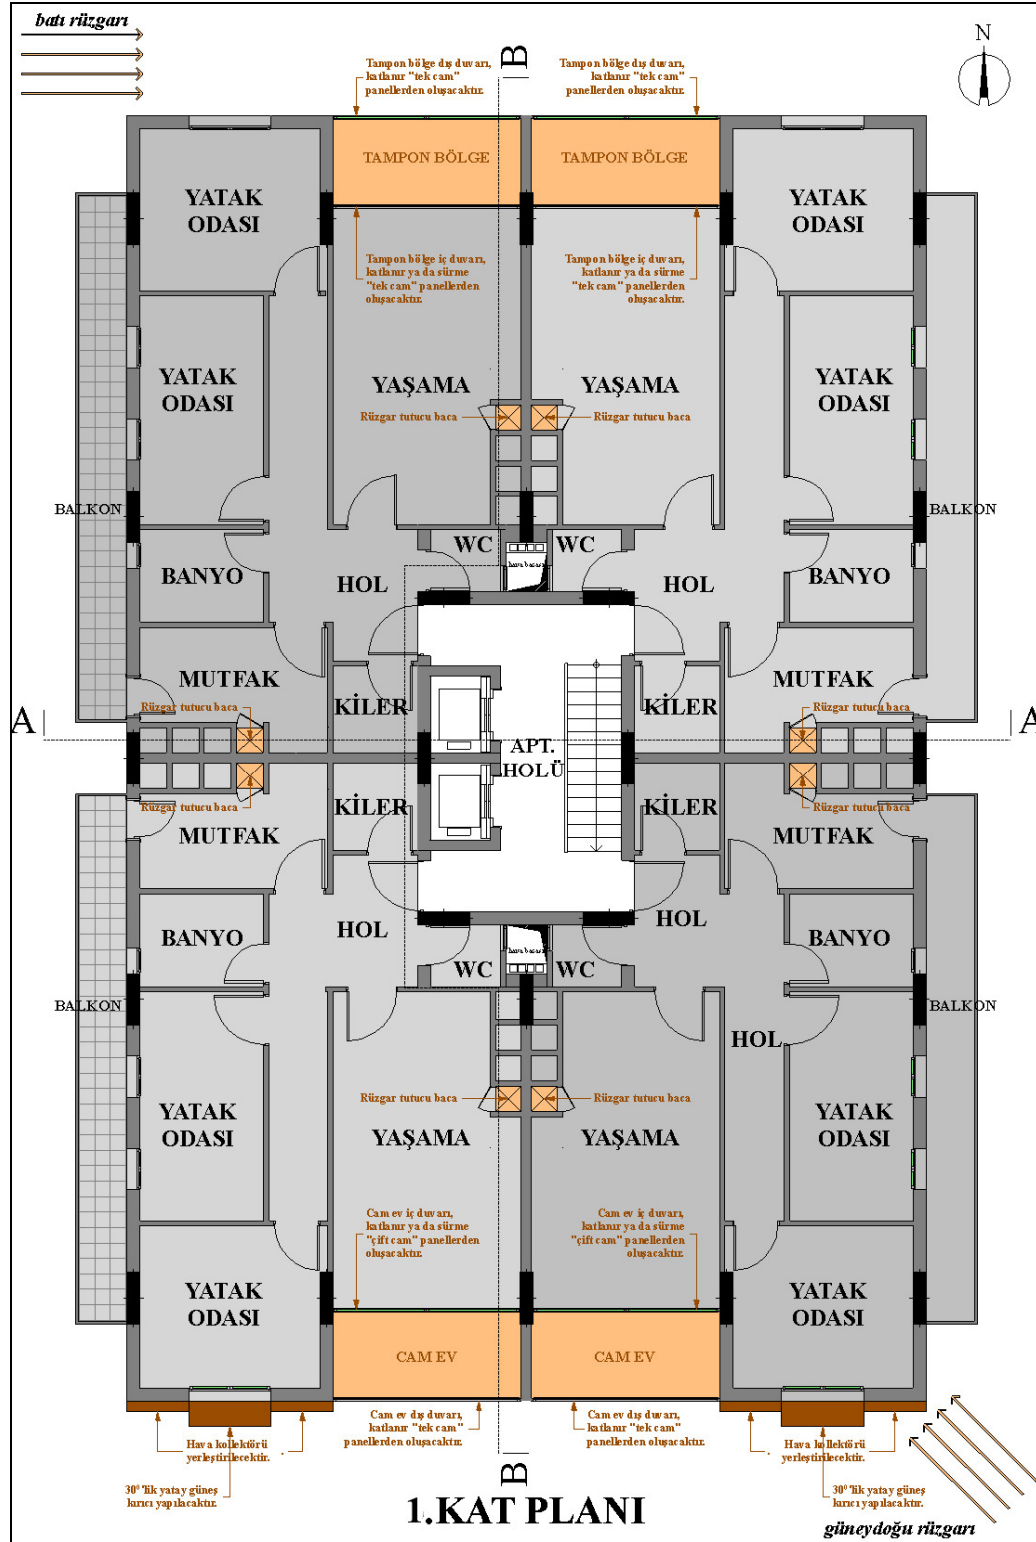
’de yapının 1. ve 7. katlarının mevcut haline ilişkin kat planları yer almaktadır. Şekil 4.22 ve 4.23’te ise, aynı katların çalışmanın 4.3 bölümünde açıklanan yapısal önlemlerin örnek yapı üzerine adapte edilmiş hali görülmektedir.
